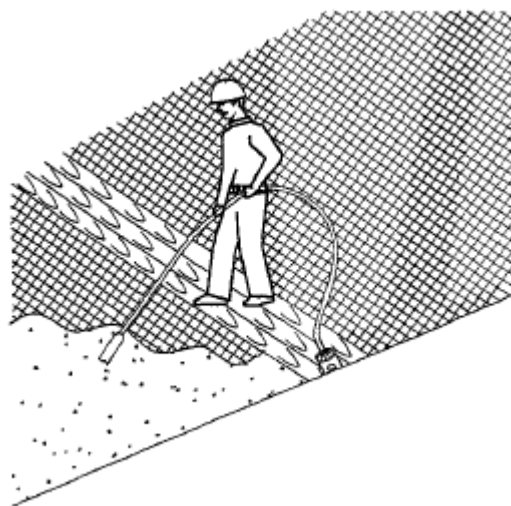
Уплотнение бетонной смеси.
